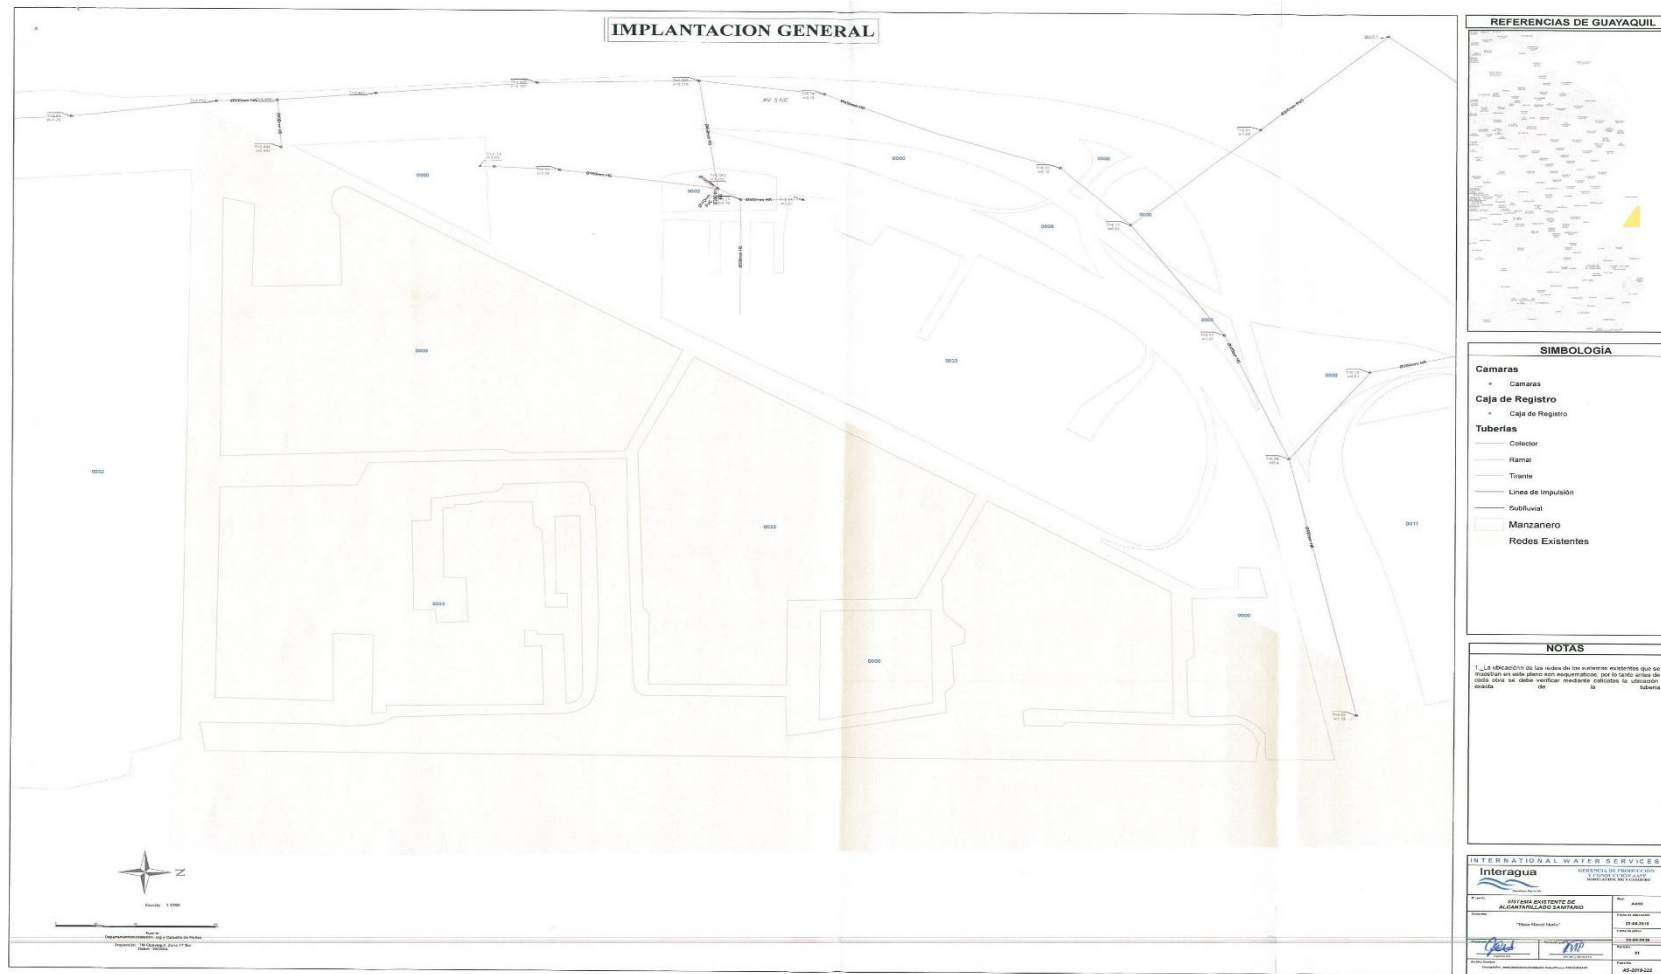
Ubicación de las redes de los sistemas existentes de alcantarillado sanitario
